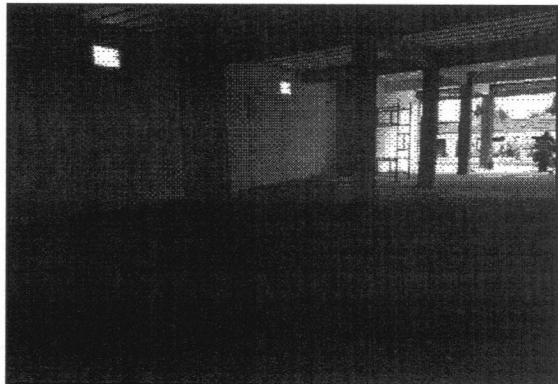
Vista do Galpão, com destaque ao piso cimentado.
